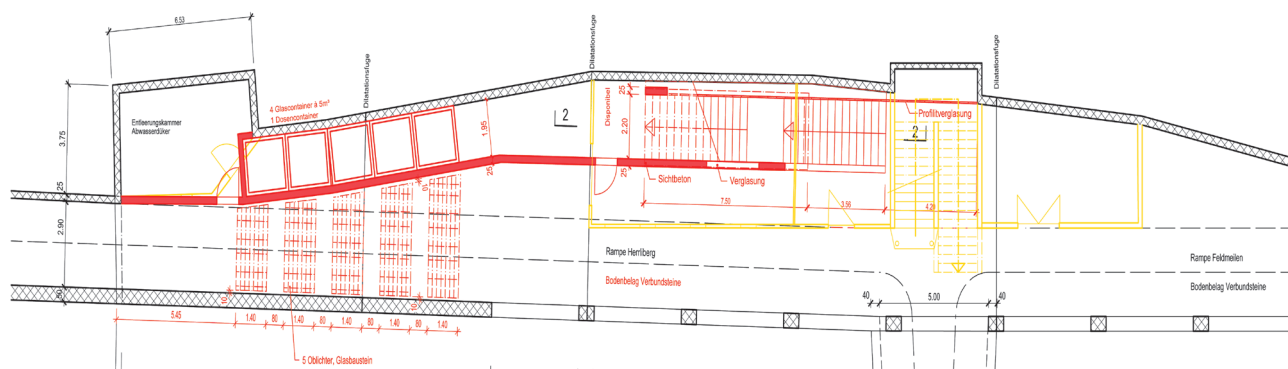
Grundriss Untergeschoss mit neuem Treppenaufgang und fünf Entsorgungscontainern.
